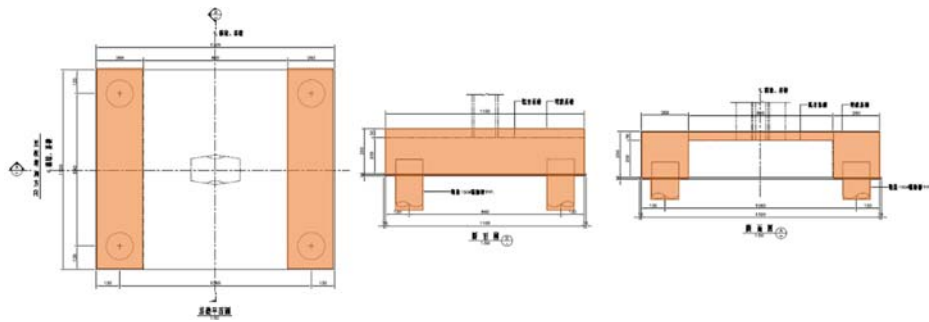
和美交流道匝道一高架橋沿垂直車行向基礎補強示意圖
